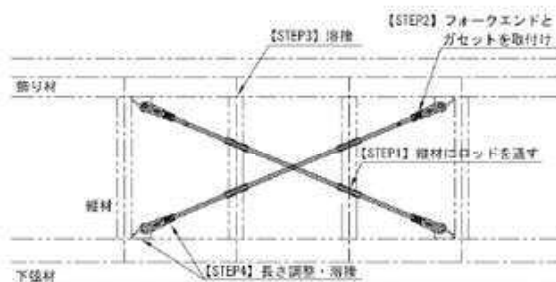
鋼管トラス、ブレイキトラスの組立て方法(平面図)
